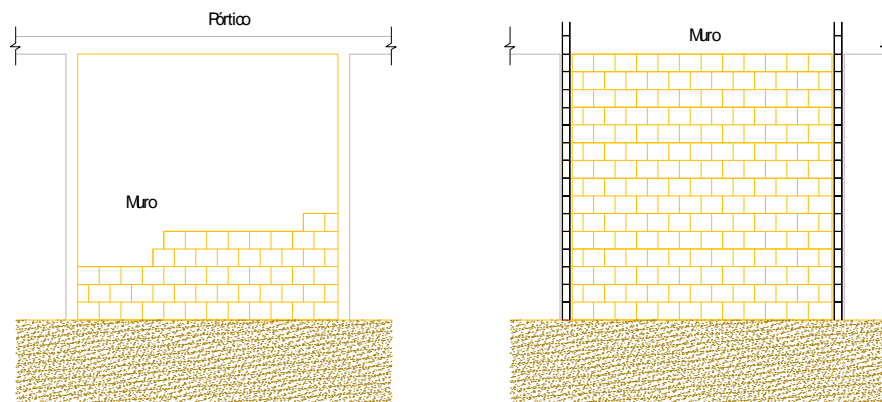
Procedimientos para el levantamiento de la mampostería
